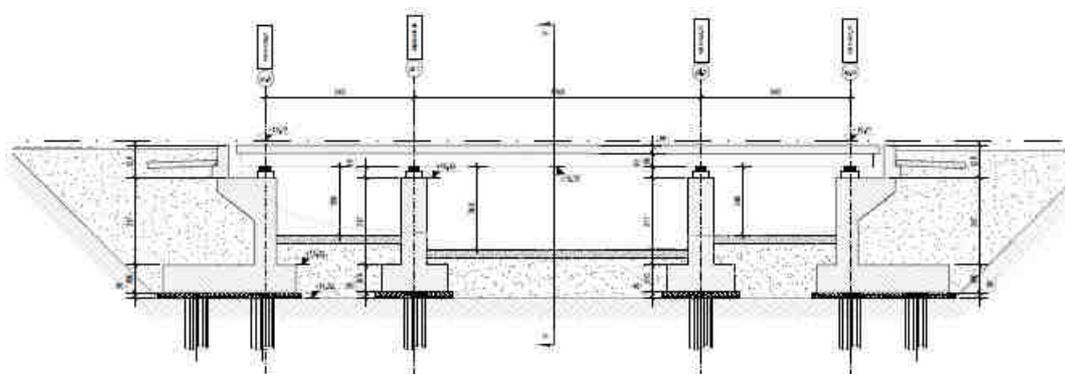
Sezione longitudinale -- Ponte RioSalius
